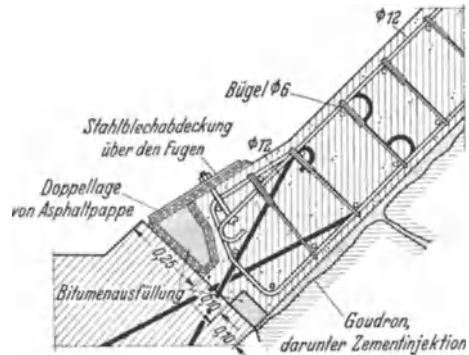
Bakhada-Staudamm. Vorläufige Eisenbetondichtungsdecke.
